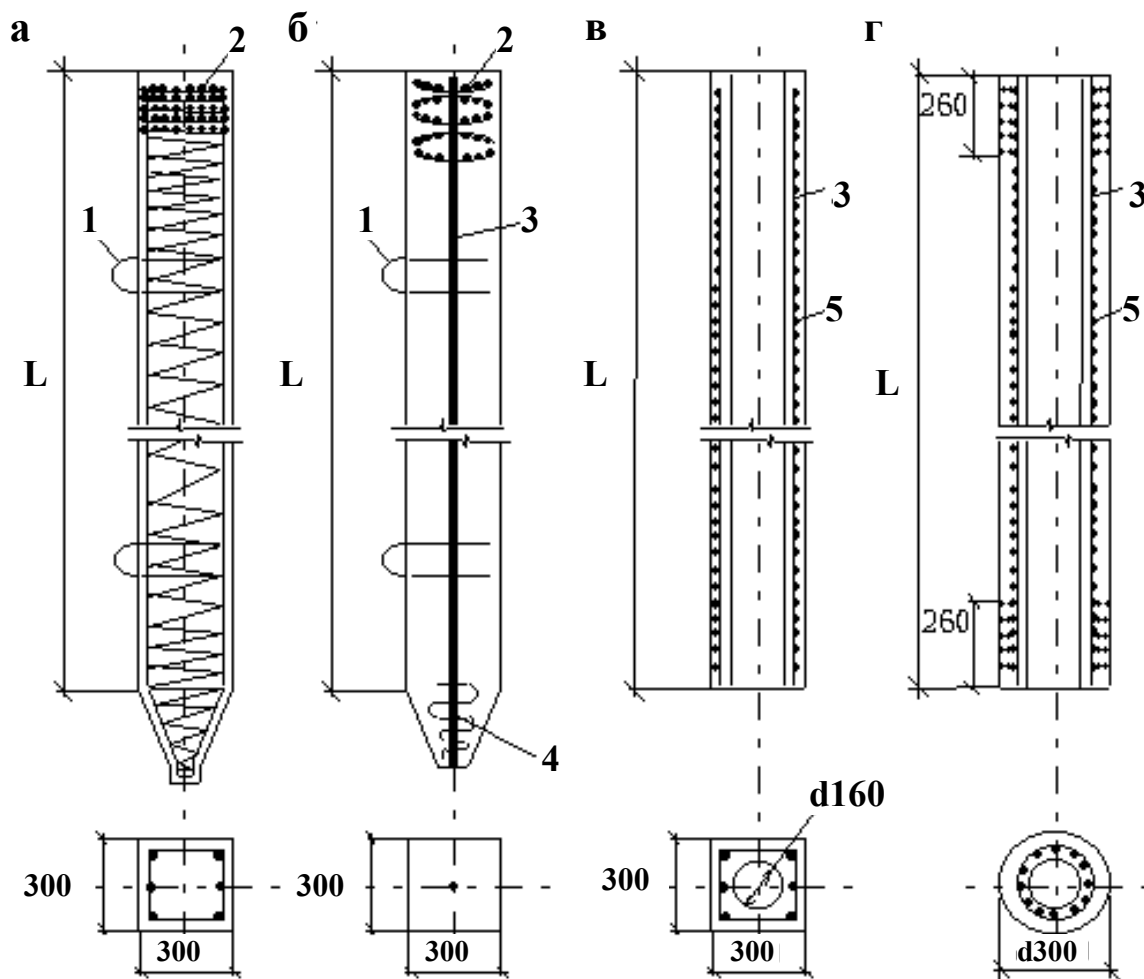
Конструкція і перетин залізобетонних паль: а – призматична з поперечним армуванням стовбура; б – те саме без поперечного армування стовбура; в – те саме з круглою порожниною; г – порожниста кругла: 1 – стропальна петля; 2 – арматурні сітки голови; 3 – повздовжня арматура; 4 – спіраль вістря; 5 – поперечна спіральна арматура
